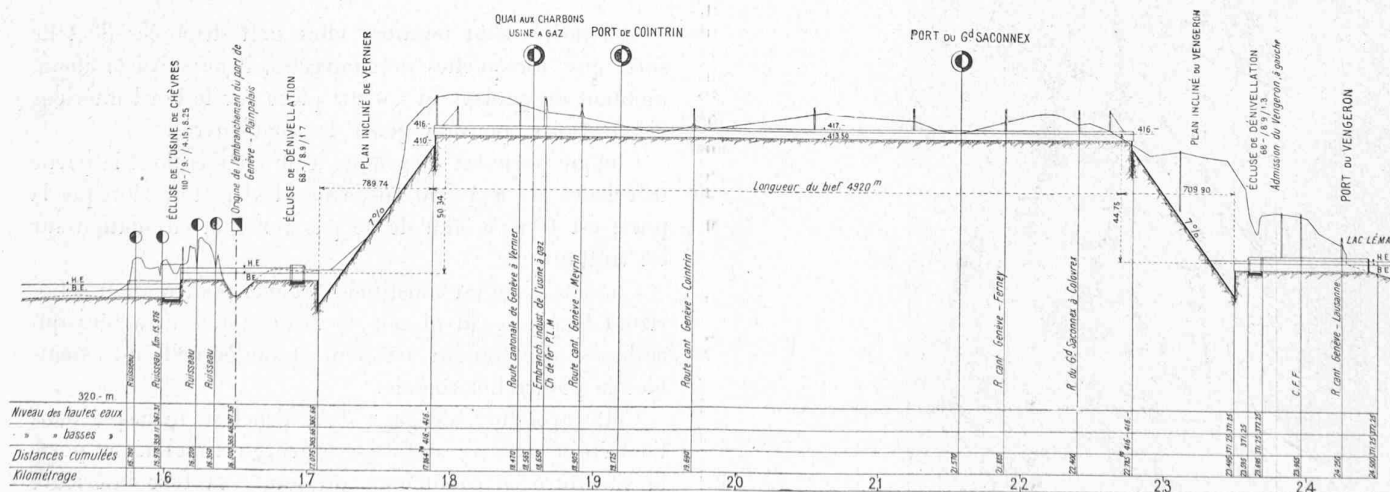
Profil en long de la section Usine de Chèvres-lac Léman. — Echelles : longueurs 1 : 50000, hauteurs 1 : 2500.
